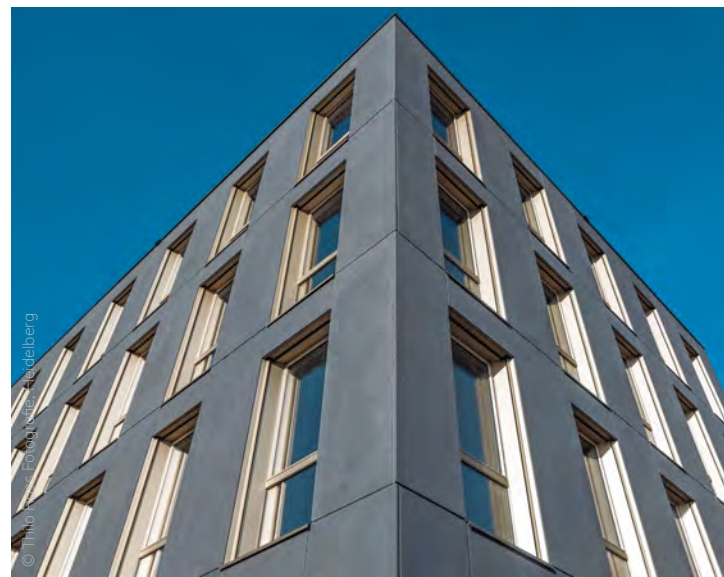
Fassadelemente aus Recyclingbeton unter Verwendung des vor Ort rückgebauten Gebäudes als Beton- und Ziegelrezyklat, HERING Bau.
